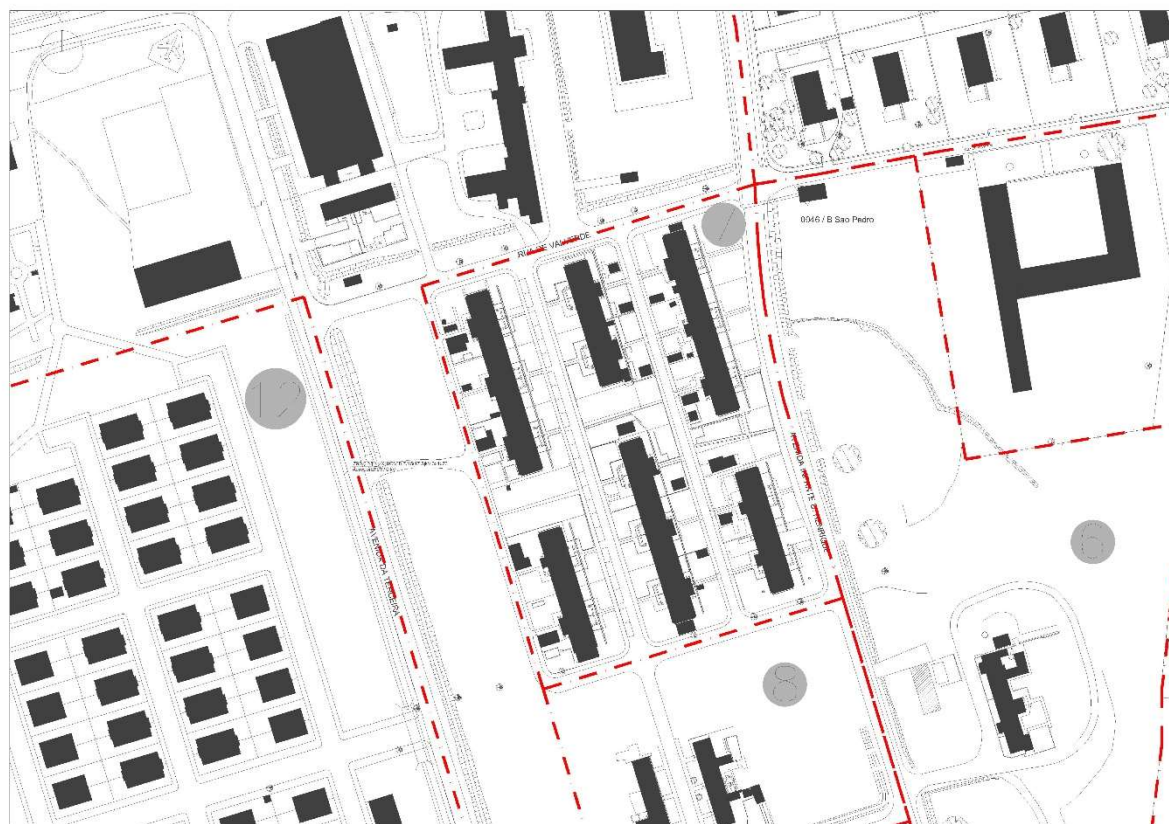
Planta do Bairro Infante D. Henrique (Extrato de Planta Cedida Pelas Ilhas de Valor)
